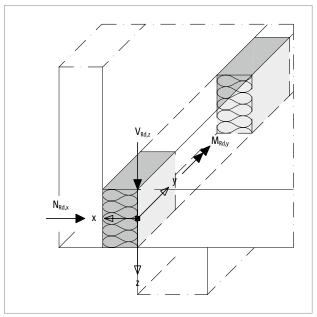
Schöck Isokorb® T tipo AP: regola dei segni per il calcolo dei parapetti anteposti
